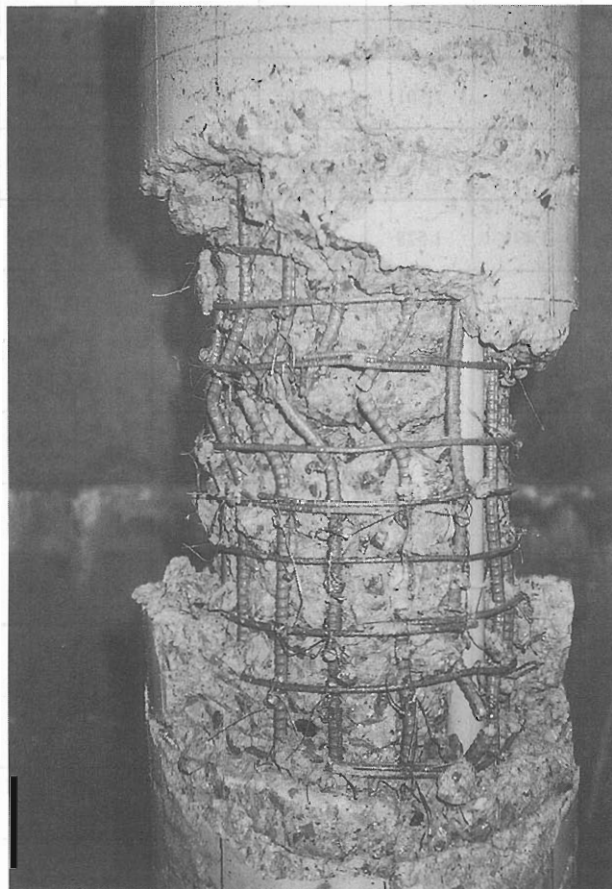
杭体損傷状況④（ケース5：鉄筋コンクリート杭コンクリート除去後）
